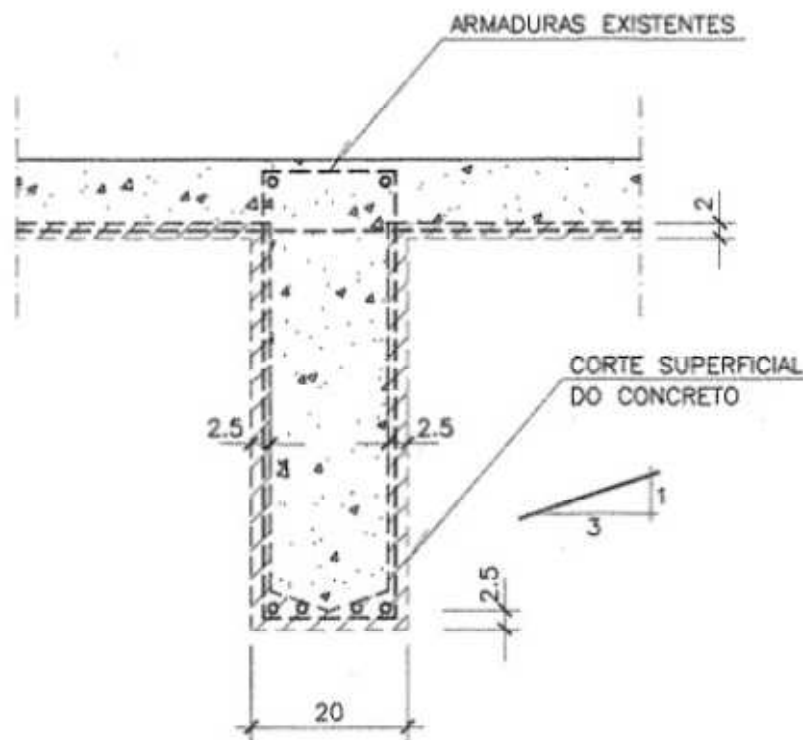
Projeto de corte da estrutura do prédio de apoio.
